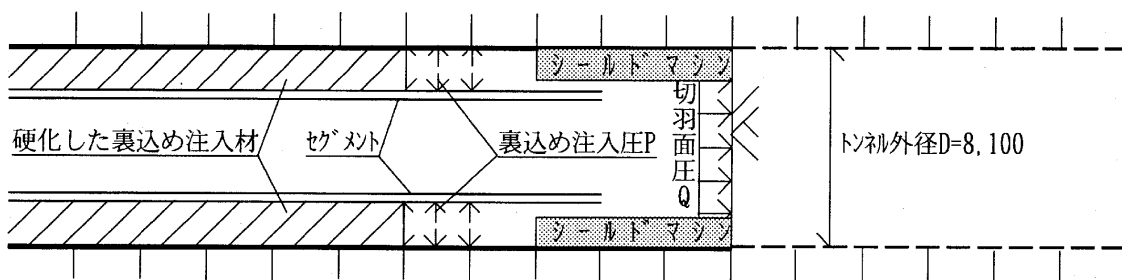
宮川らの施工過程のモデル化<sup>8)</sup>
